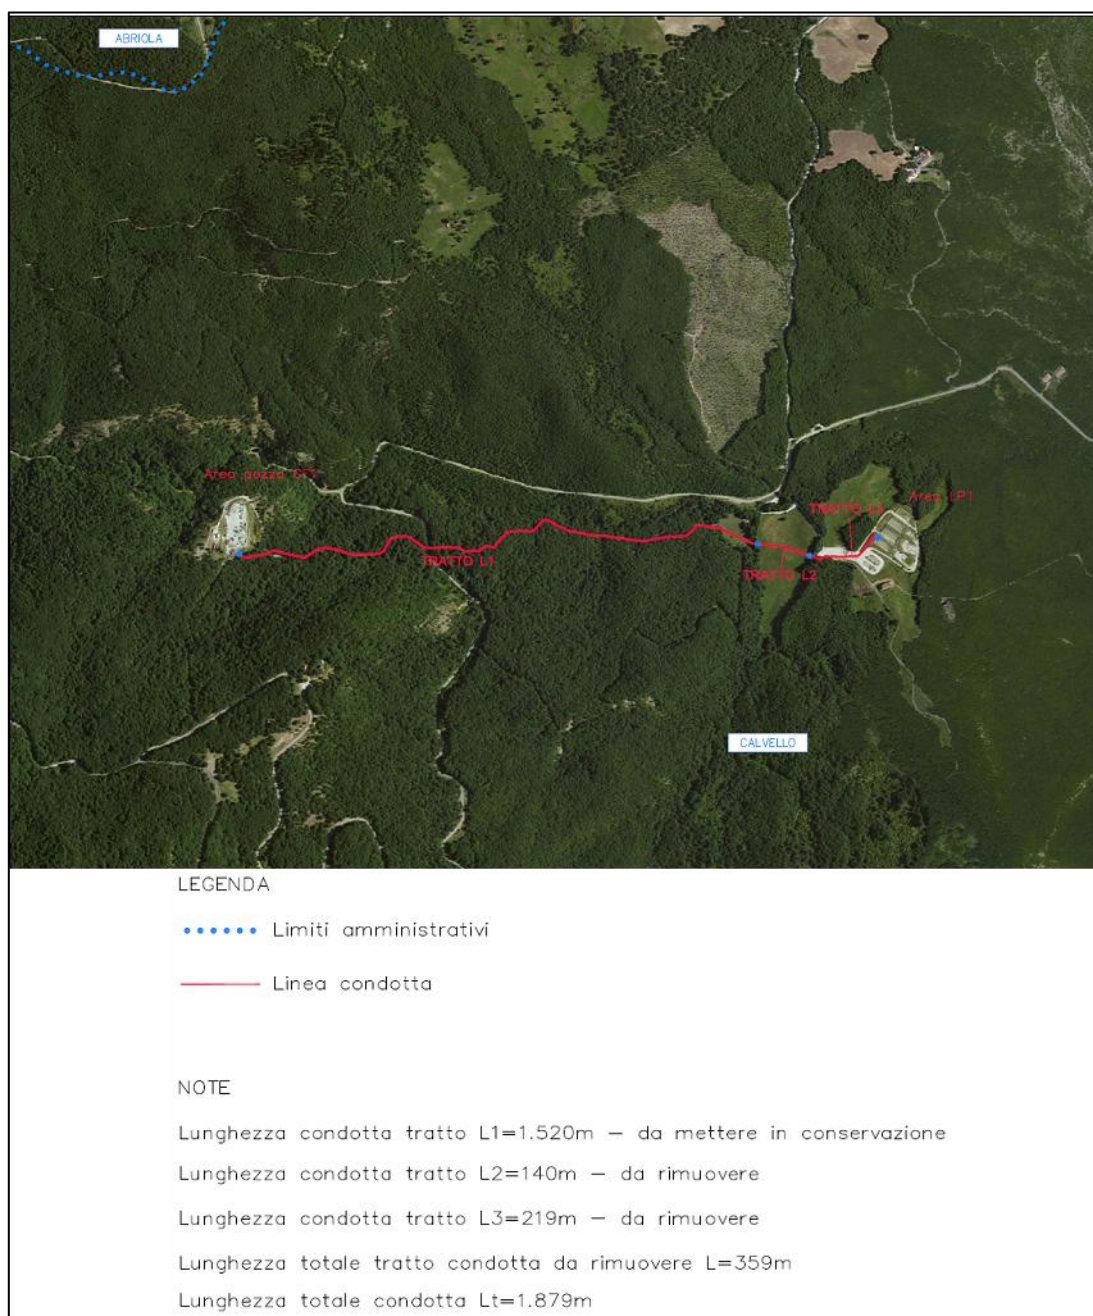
Condotta di collegamento area LPT-CF – pozzo Cerro Falcone 1.
